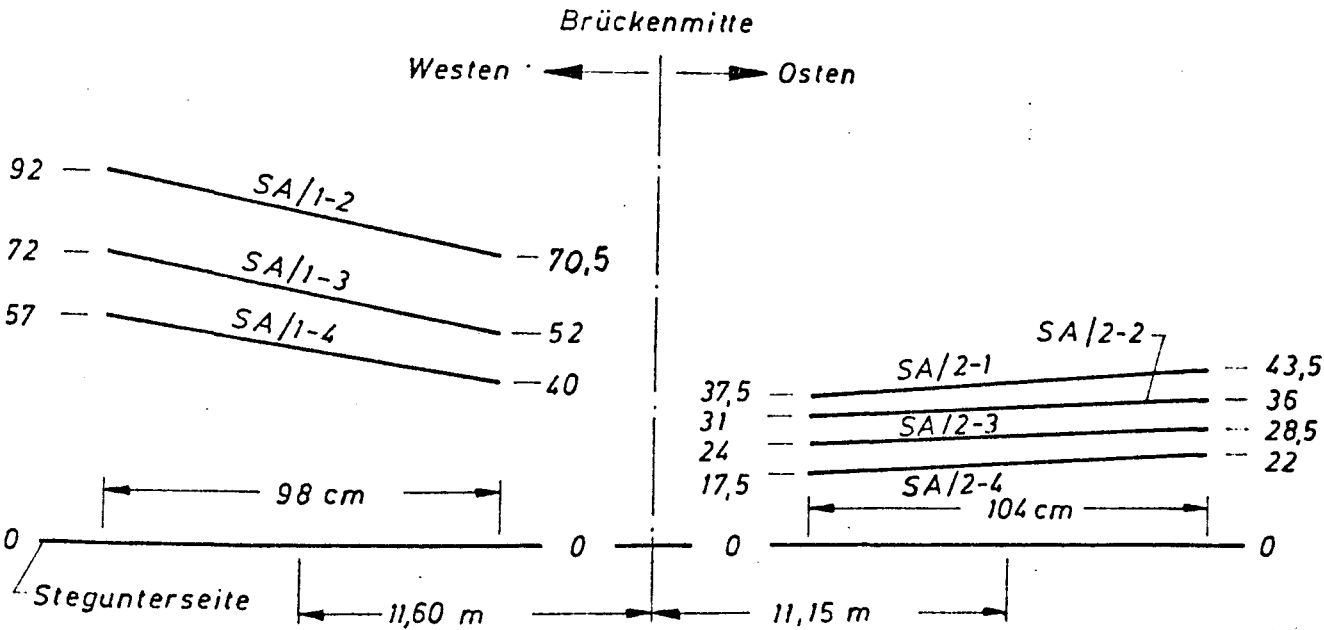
Detailaufnahme zu Bild 29 (der Maßstab zählt von Unterkante Steg)
